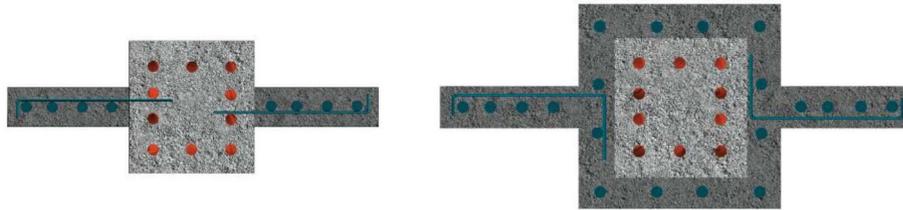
Conexión de los segmentos de muro con la columna existente: a) anclaje del refuerzo horizontal en la columna; b) anclaje del refuerzo horizontal del muro en el encamisado de la columna. Fuente: INIFED (2021d) con base en Terán (2009)
